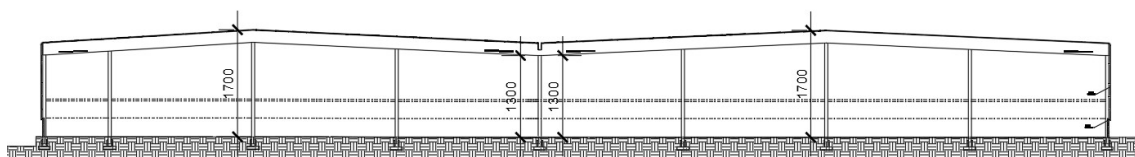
Anteprojeto: Elevação Frontal do Barracão (fonte: Arq. Marcos Faccin da Silva)
